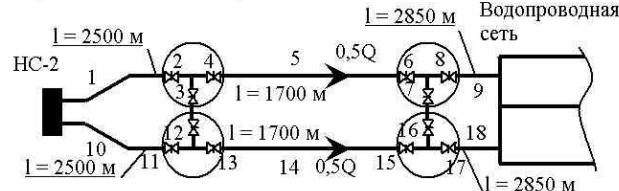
Схема водовода в 2 нитки с 2-мя перемычками
